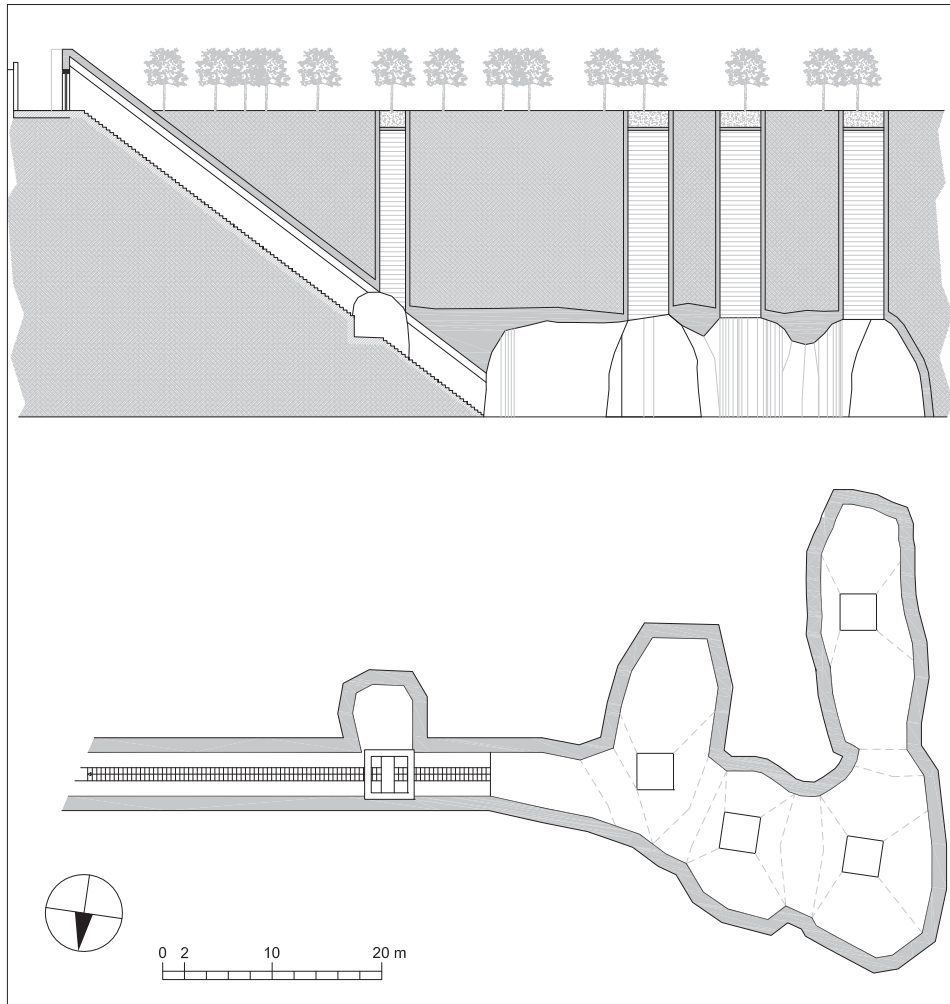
Comiziano, cantina C8. Pianta e sezione longitudinale
